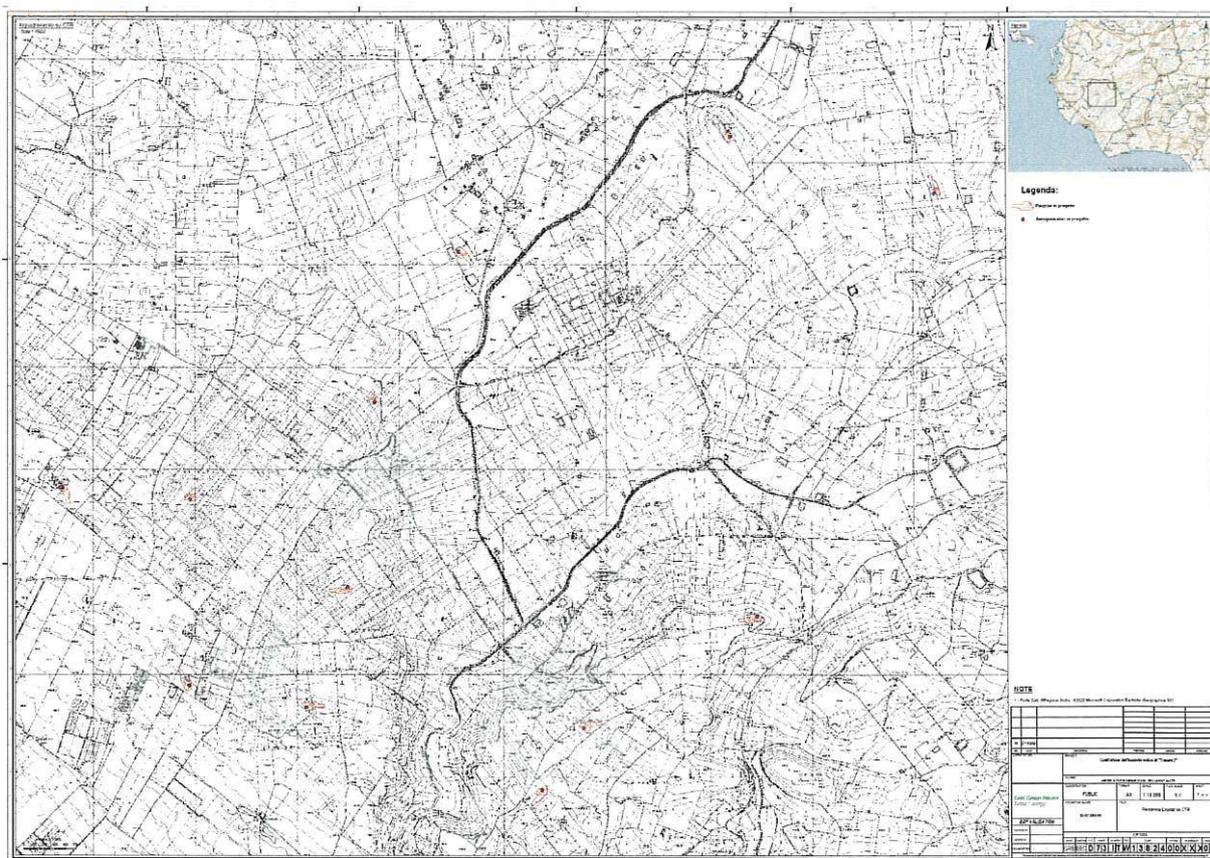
Elaborato di progetto “Revisione layout su CTR”
